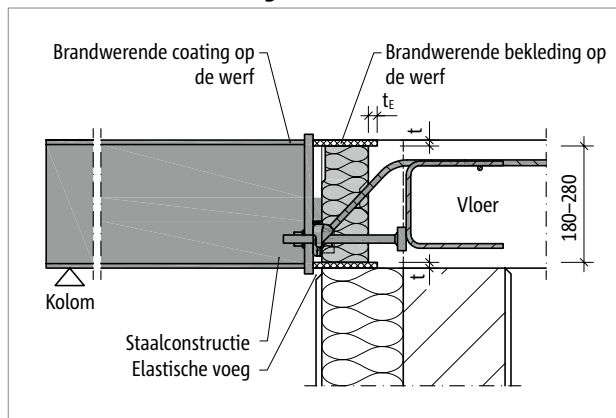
Schöck Isokorb® T type SQ-V3: Doorsnede
